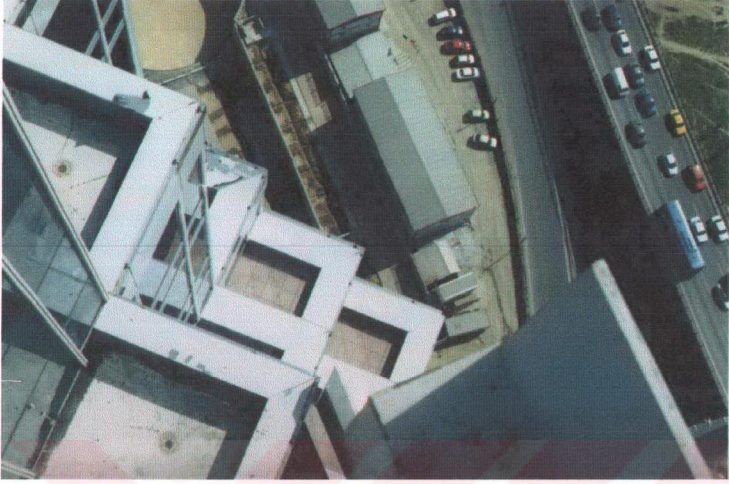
İŞ BANKASI Panel Montajı - Üst bitiş panelleri konstrüksüyonu
